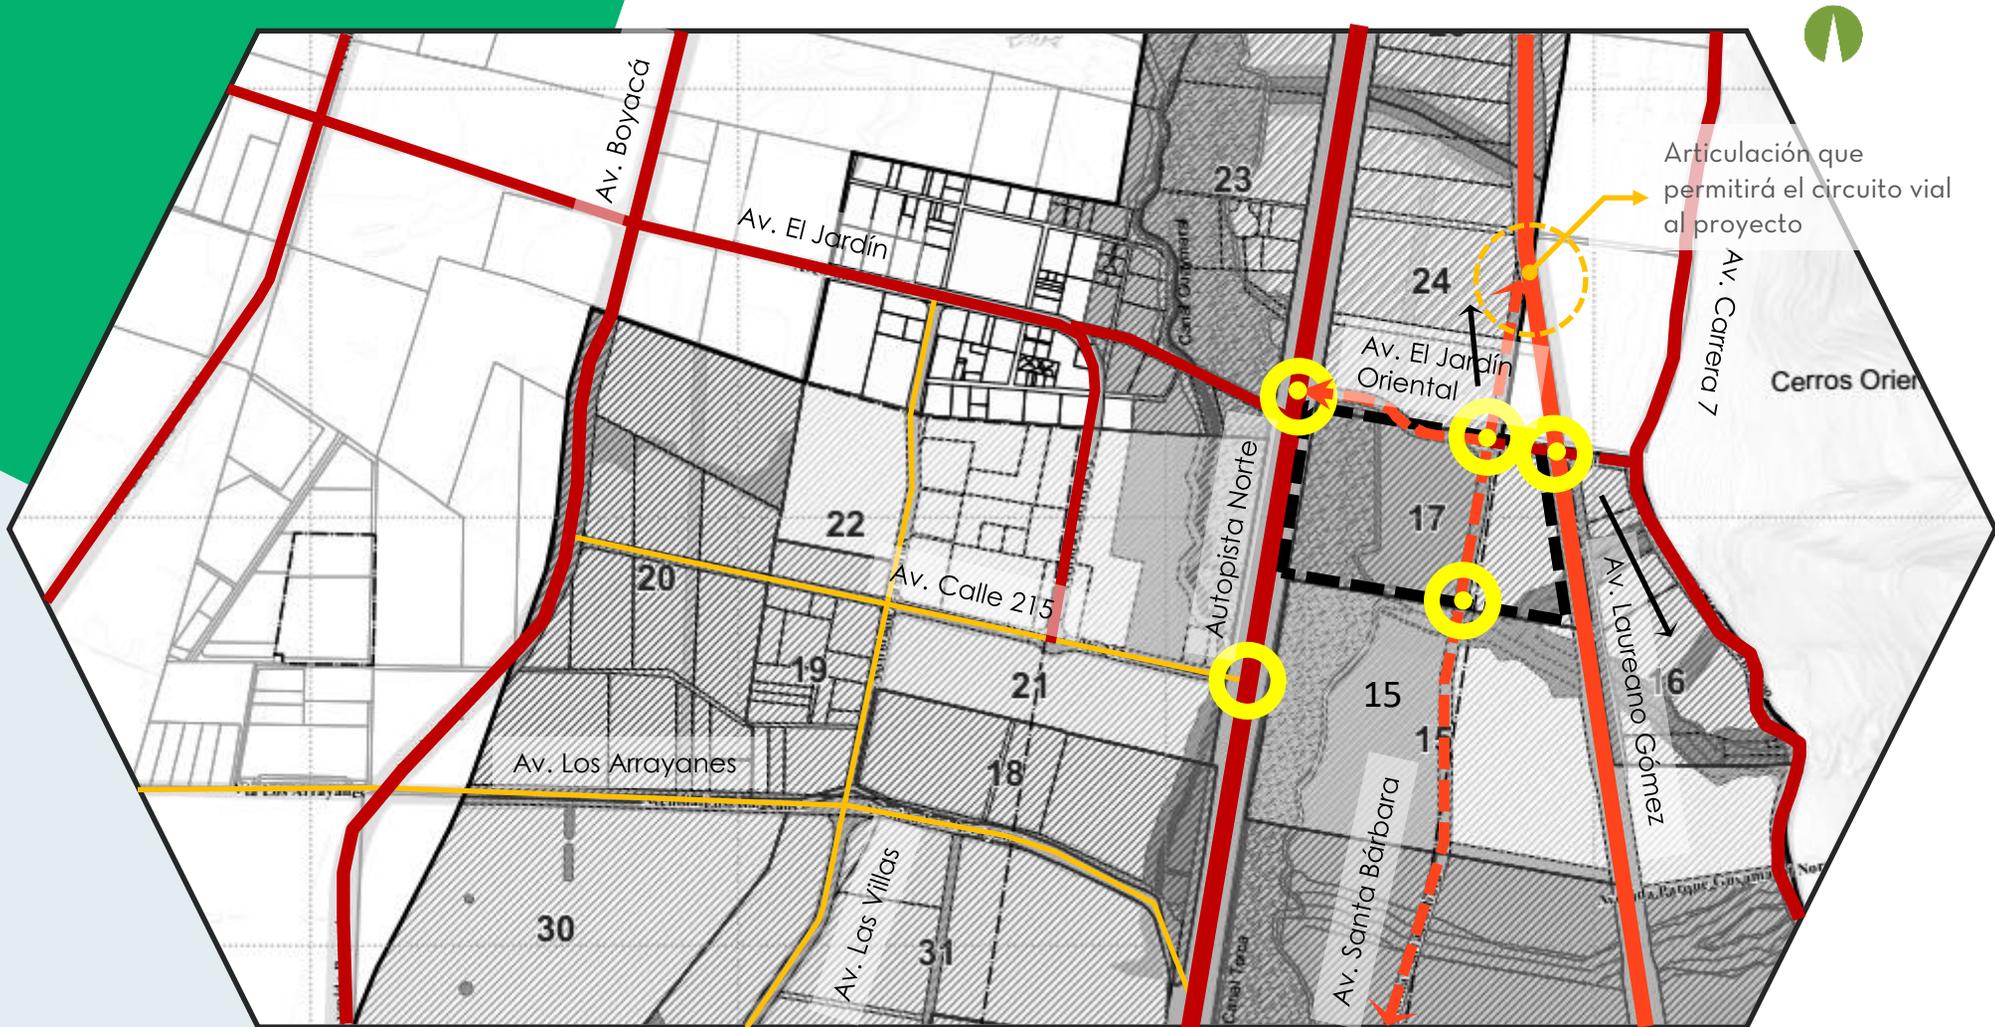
Plano Articulación Plan Parcial Lucerna con el entorno / Estructura Vial
